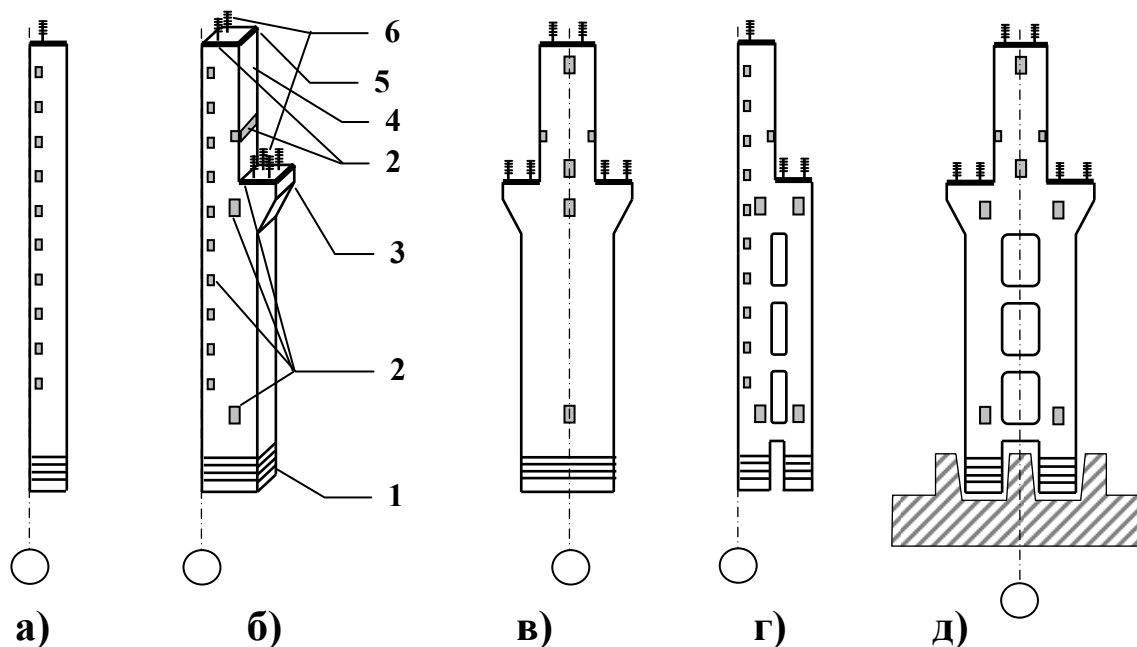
Збірні залізобетонні колони одноповерхових будівель:
